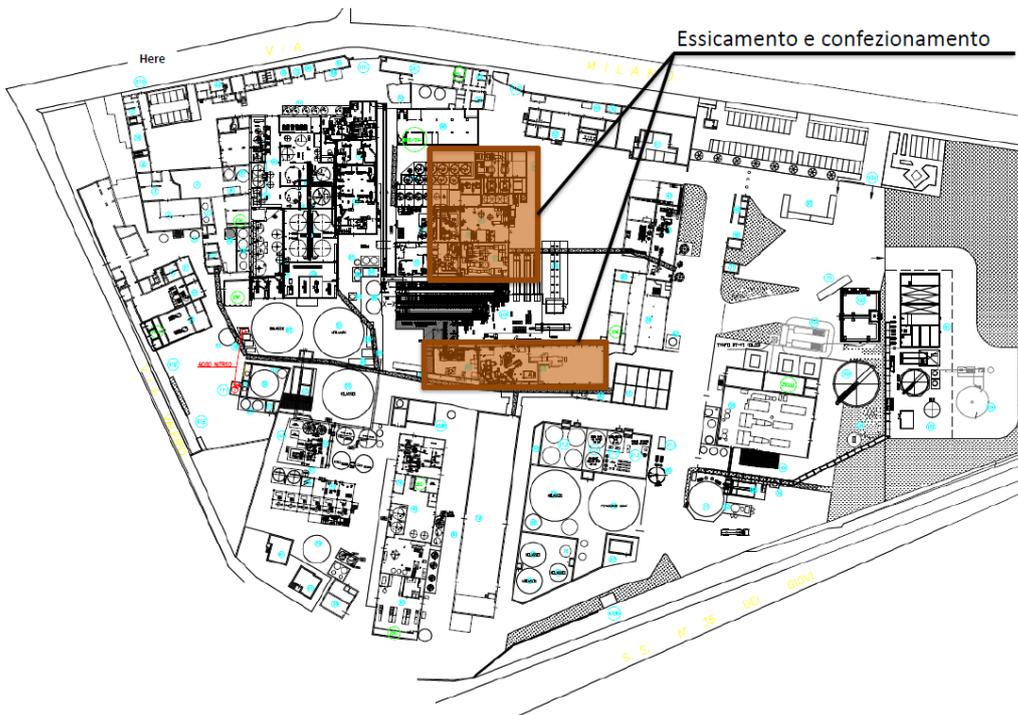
Planimetria – Reparto essiccamento e confezionamento
